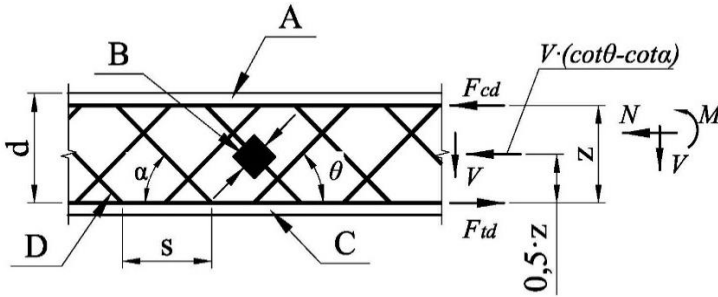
Фермова модель залізобетонного елемента з поперечною арматурою
